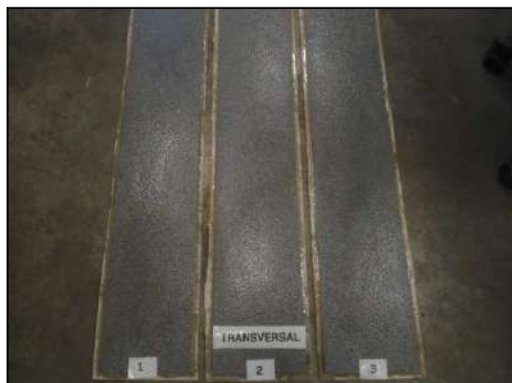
Vue des échantillons avant l'essai. Sens transversal.
